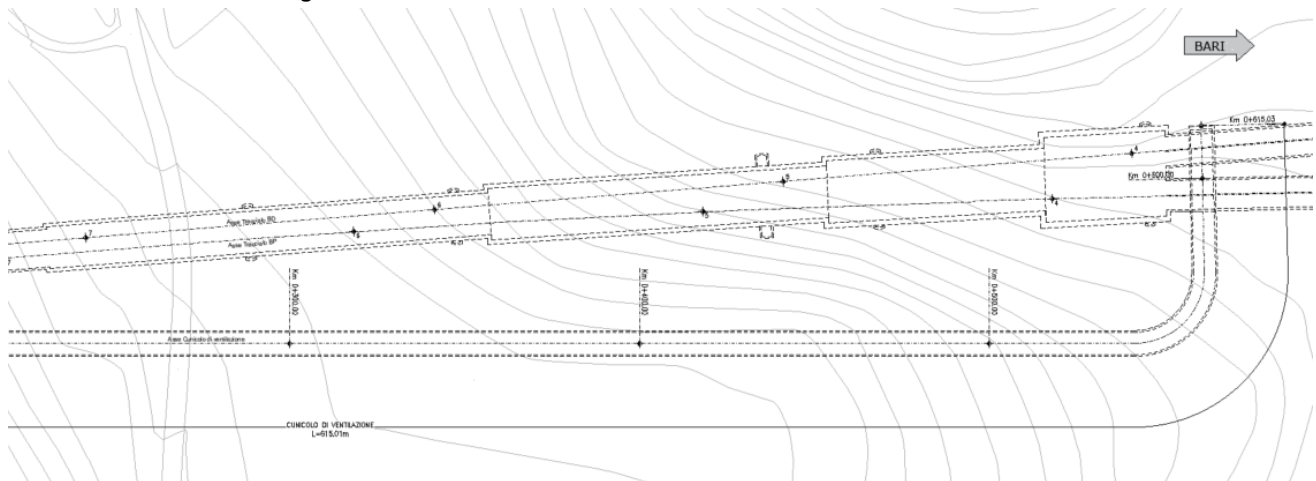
Stralcio planimetrico del camerone di diramazione a sezioni crescenti e della parte accostata del cunicolo di ventilazione
